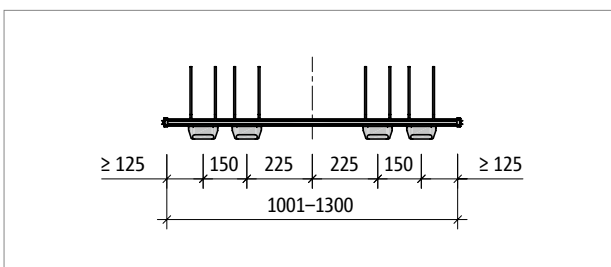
Schöck Tronsole® typ T-V2...-L700 až L1000: Půdorys prvku
